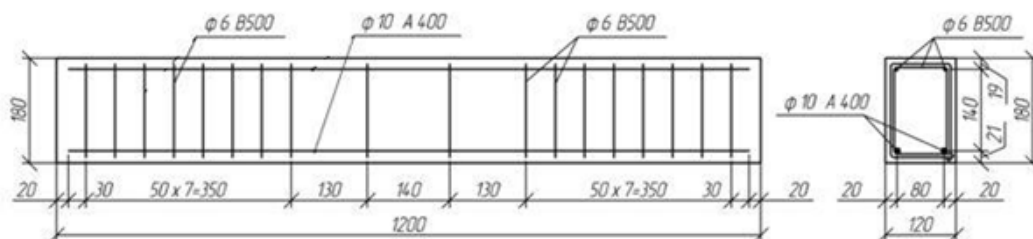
Схема армирования ЖБ и ФЖБ балки.
